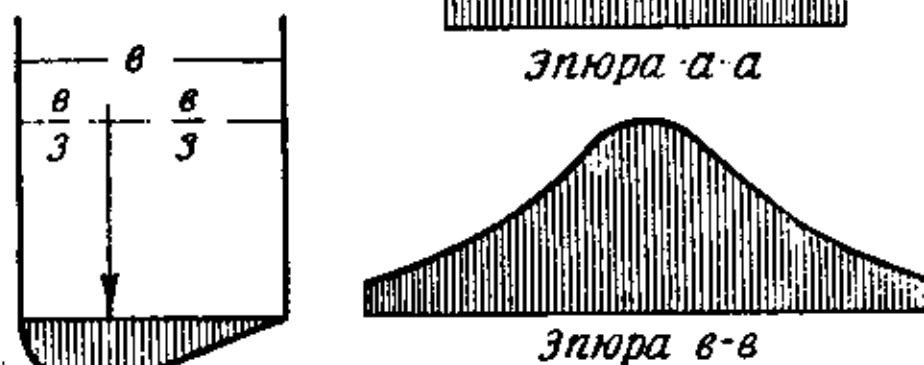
Влияние заглубления фундамента на вид эпюры
